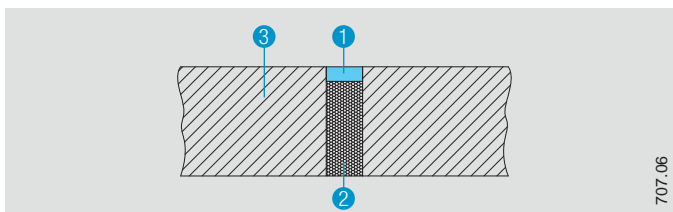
Detail C - Bauteilfuge in Massivdecke mit nicht brennbarer Hinterfüllung
